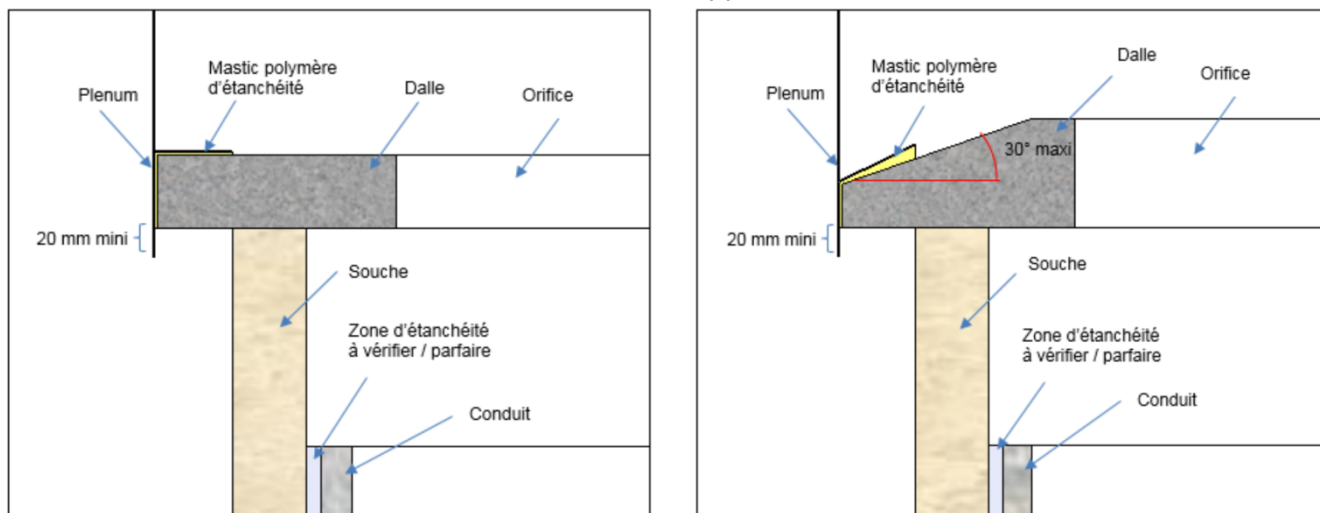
Coupe verticale d'un plenum de recouvrement sur souche
